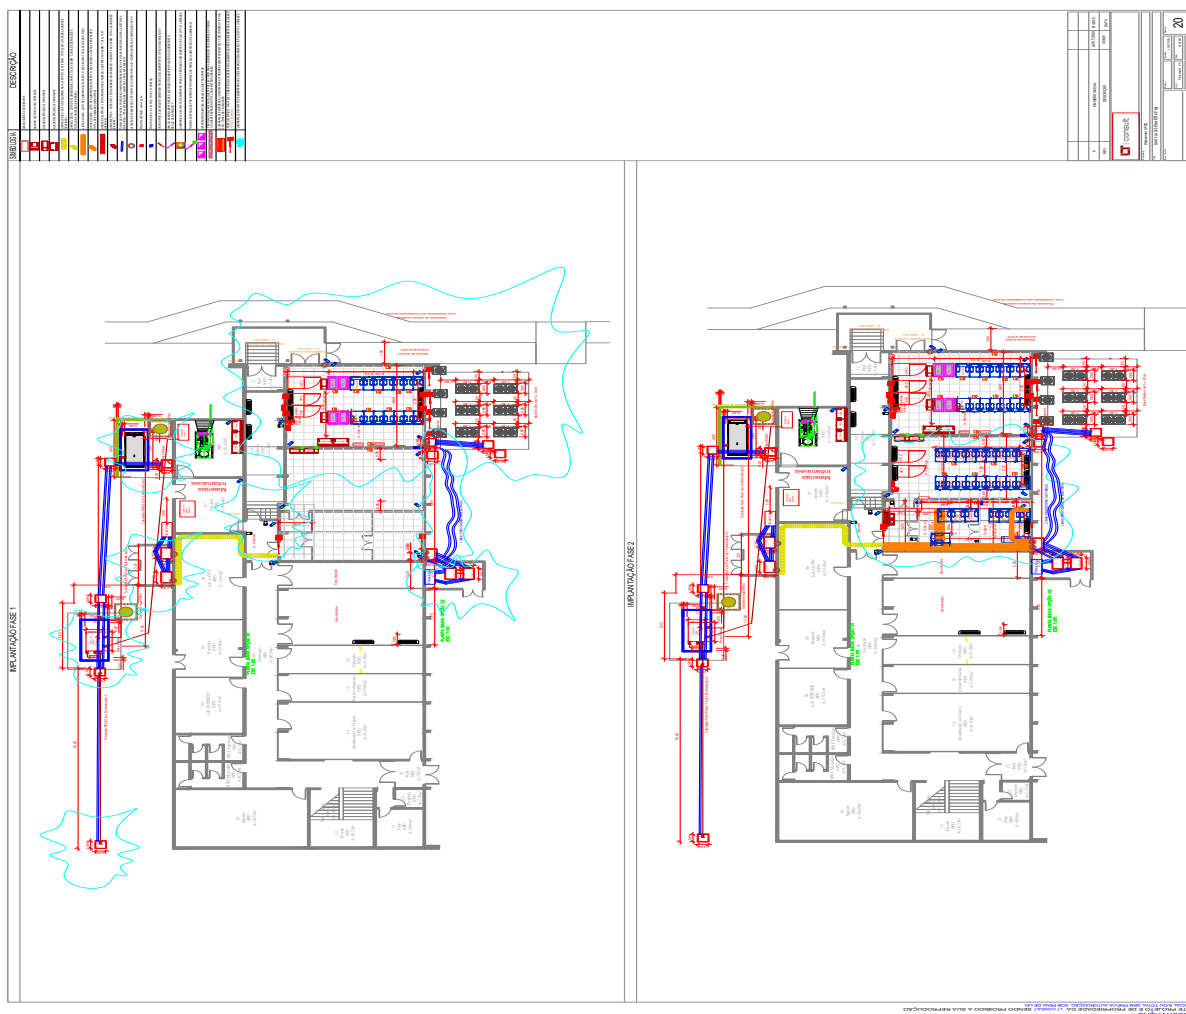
Anexo XX - Layout de fases-R20 rev 01-CIV-02
